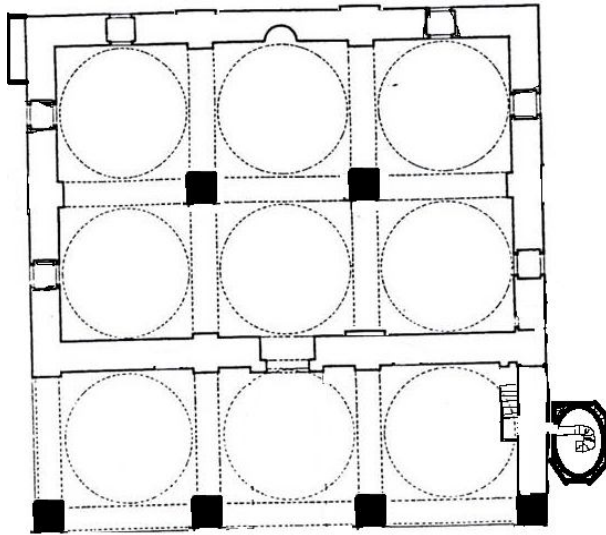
مسقط افقي لجامع سنان باشا بالقاهرة.
